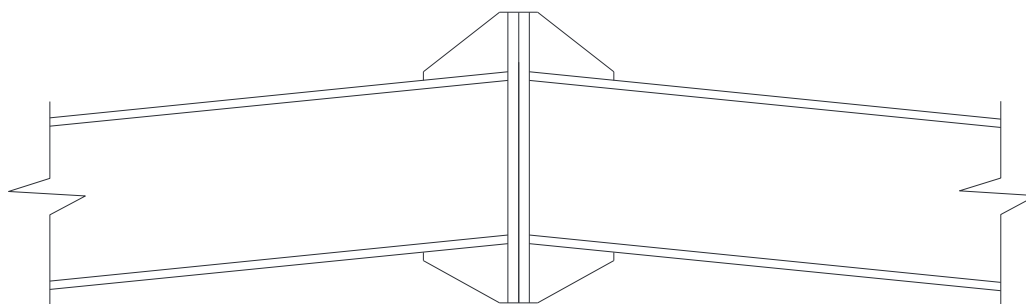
Nó do Pórtico para Duplo Pavilhão
